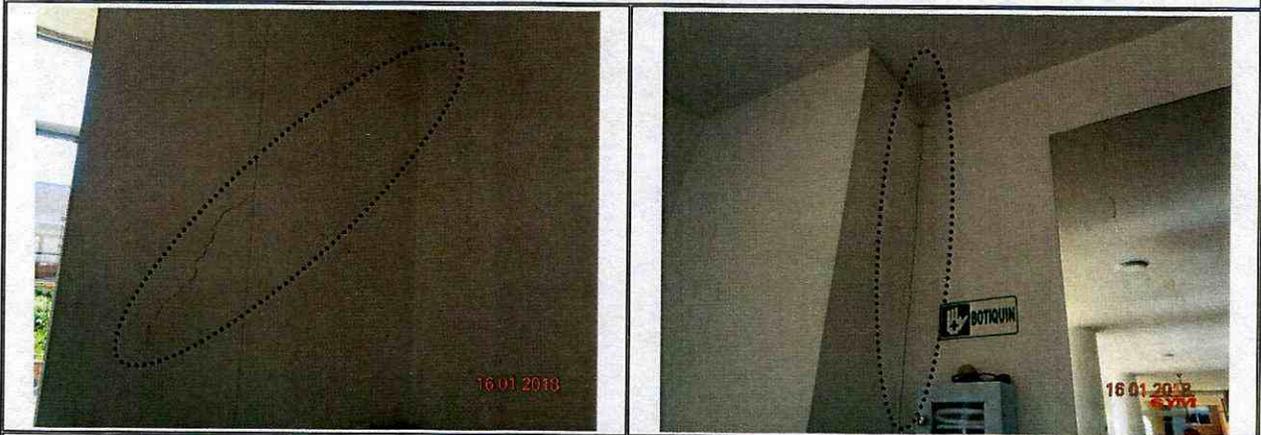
y 6. Daños en elementos no estructurales de las torres 4 y 5
